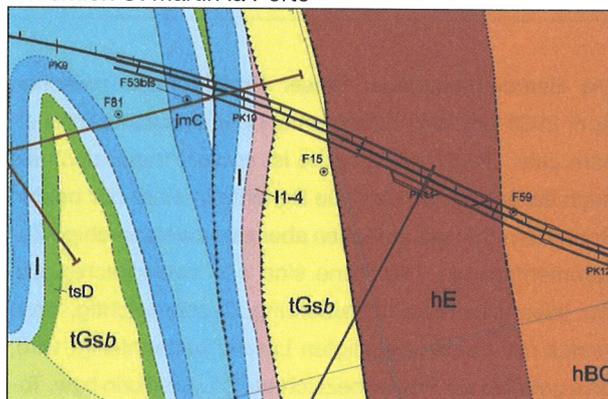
Geologischer Horizontalschnitt bei der Site d'intervention St Martin la Porte
